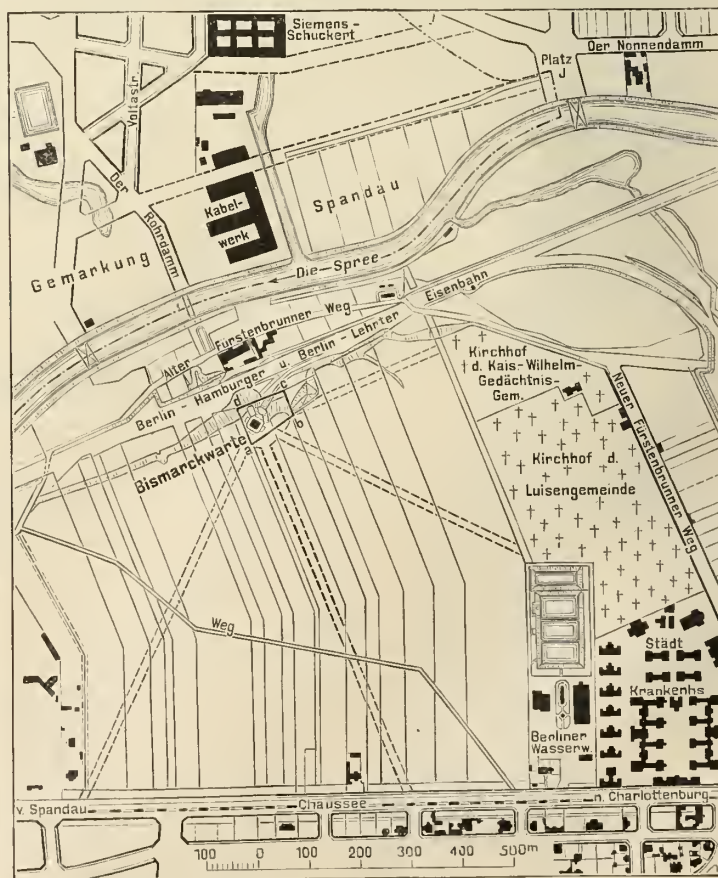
Lageplan der Bismarckwarte für Berlin.
